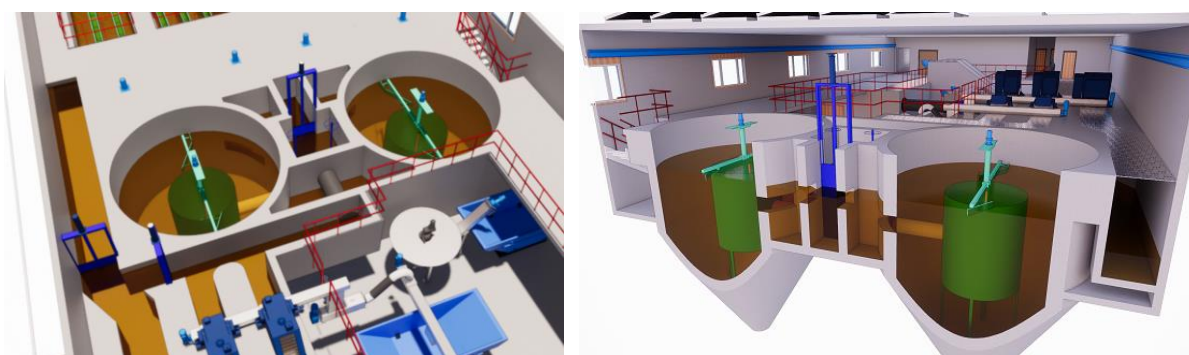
Vue 3D de l'implantation de l'étape de dessablage déshuilage
